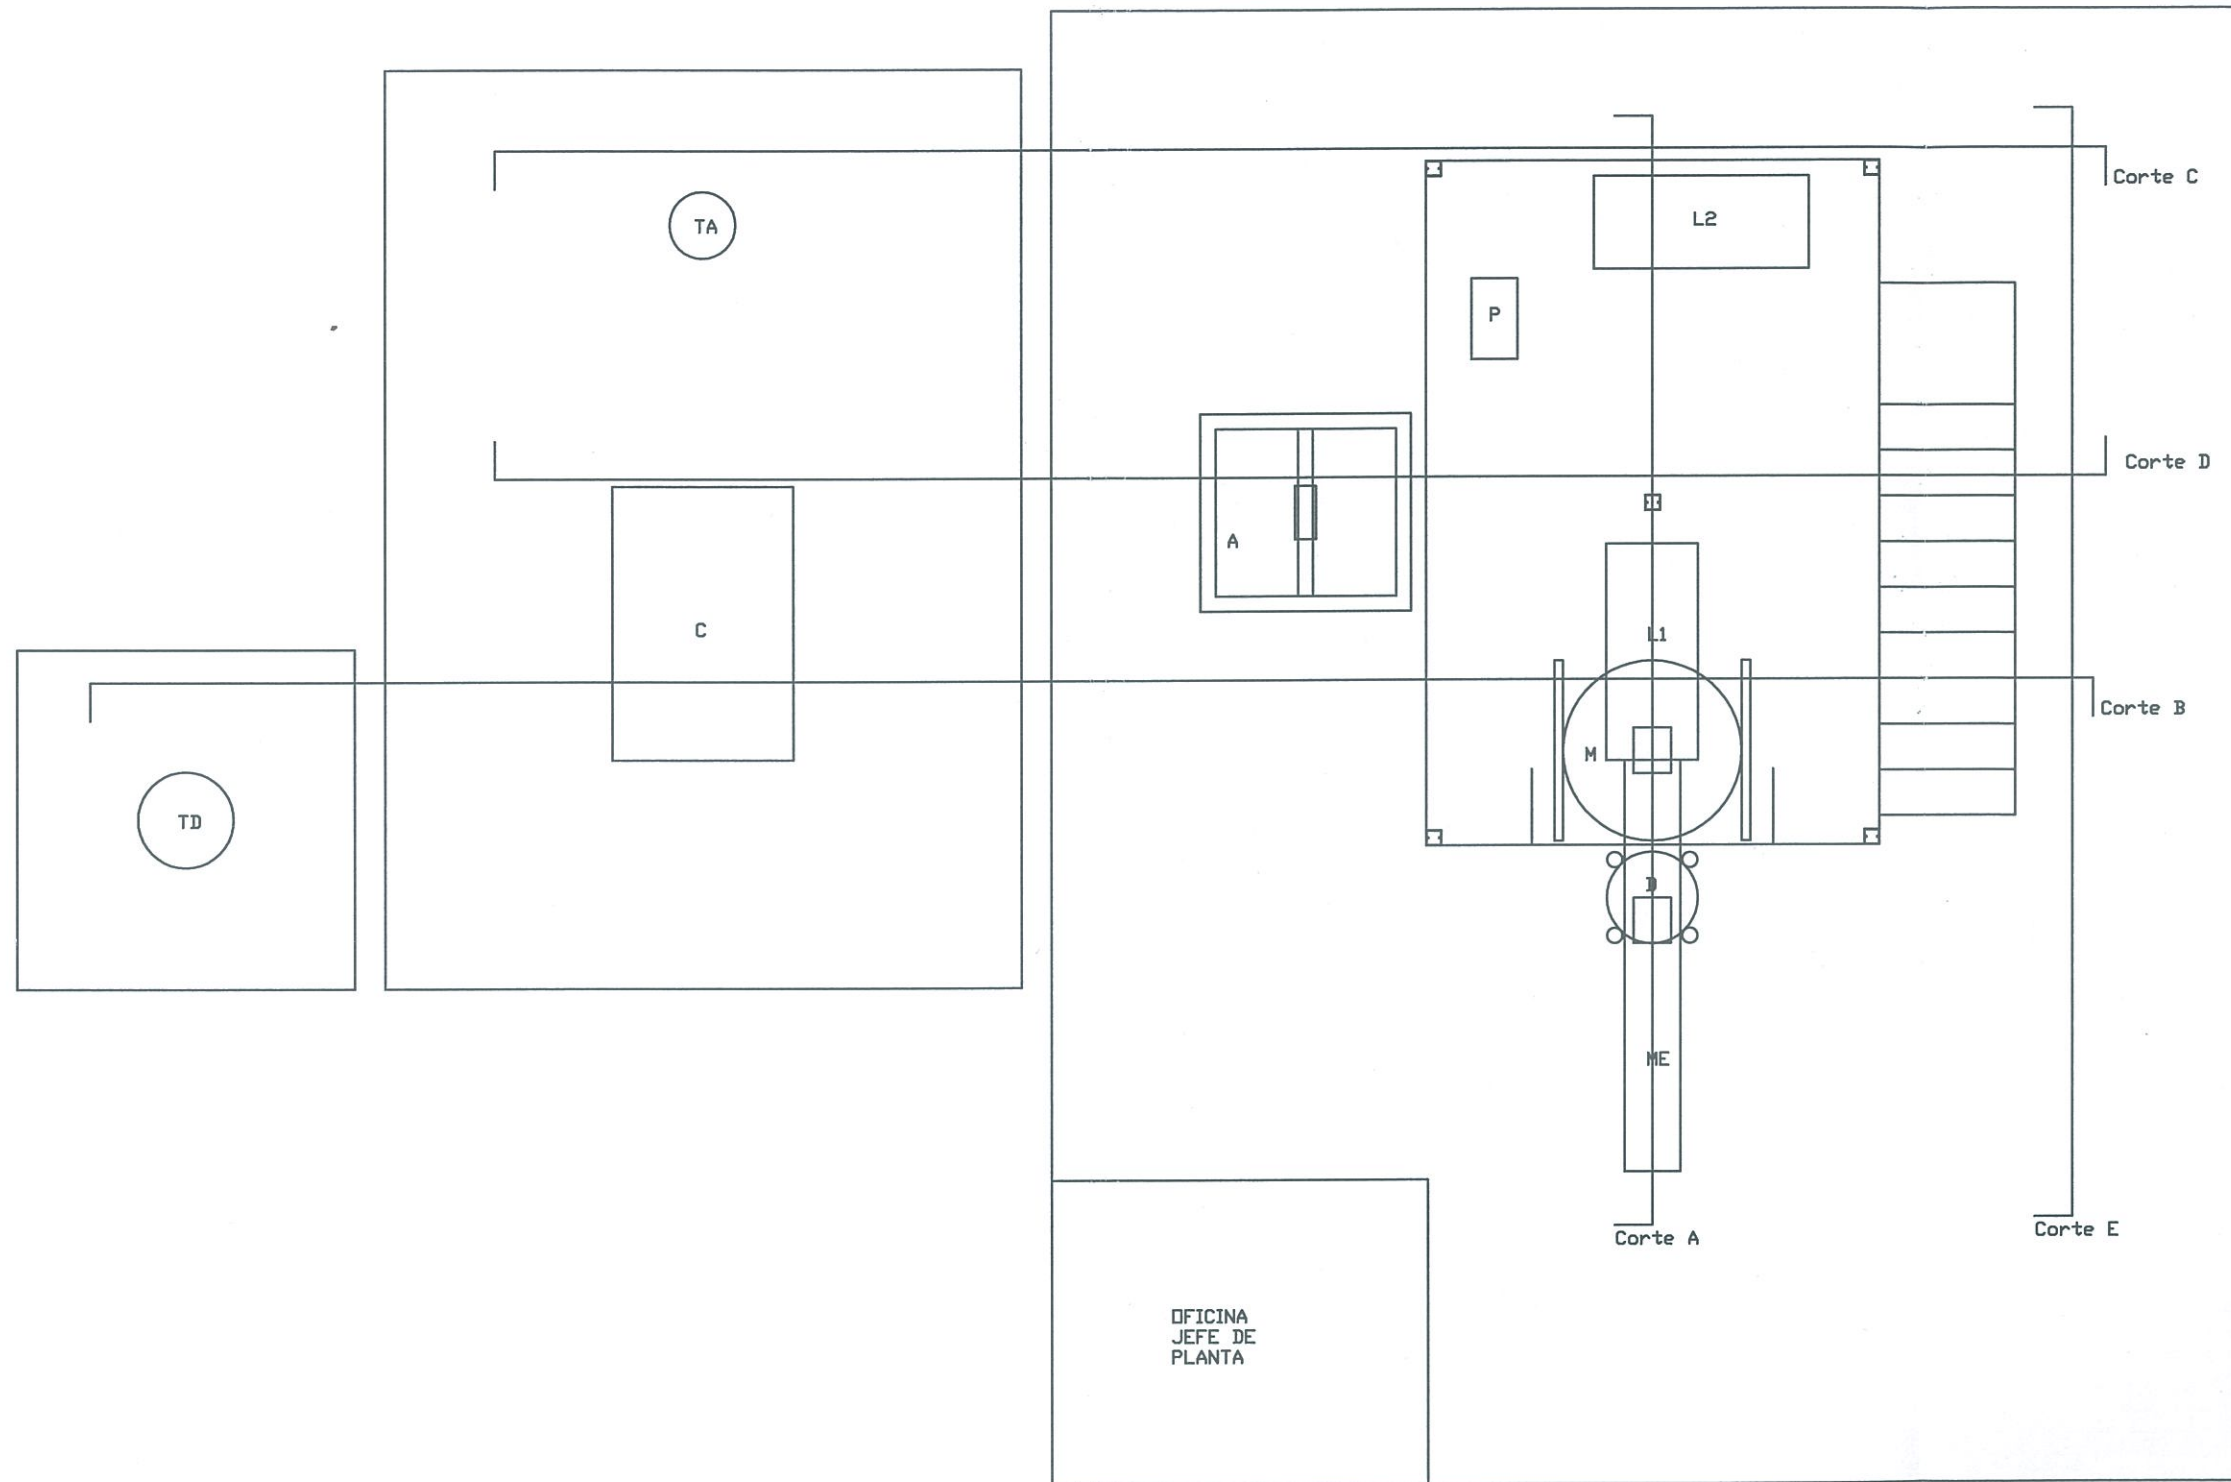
Vista Superior de la Ubicación de los Cortes de las Vistas en la Planta Industrial
